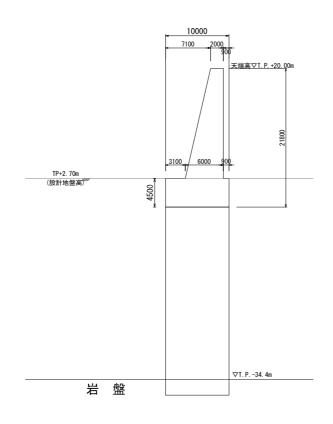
鉄筋コンクリート防潮壁断面図(B-B断面)
